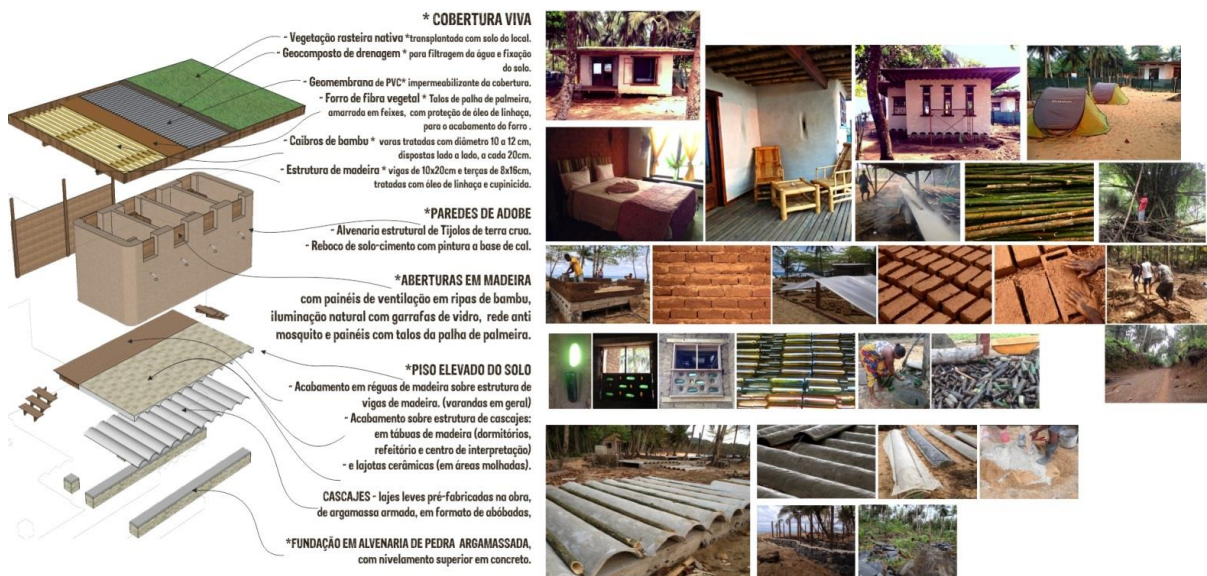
Perspectiva explodida e fotos do sistema construtivo
